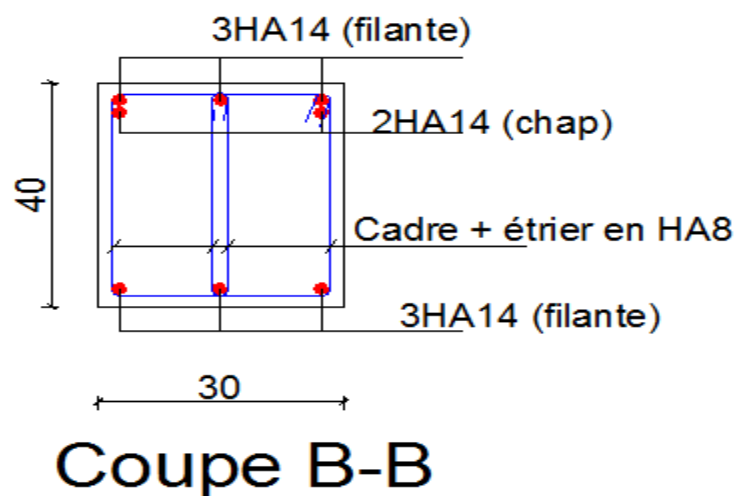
4: Ferrailage sur appuis d'une poutre principale.
